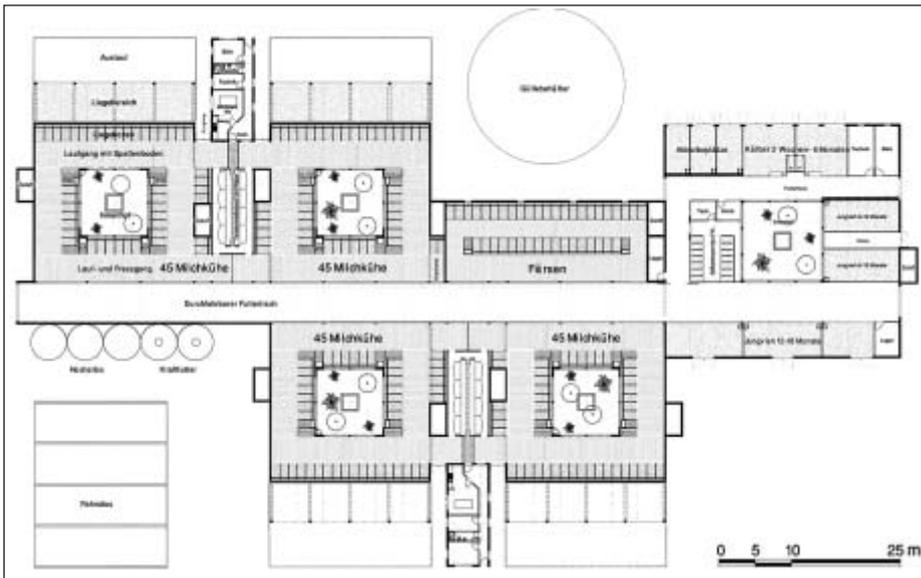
Grundriss des beschriebenen Stallgebäudes für 180 Milchkühe und Nachzucht
